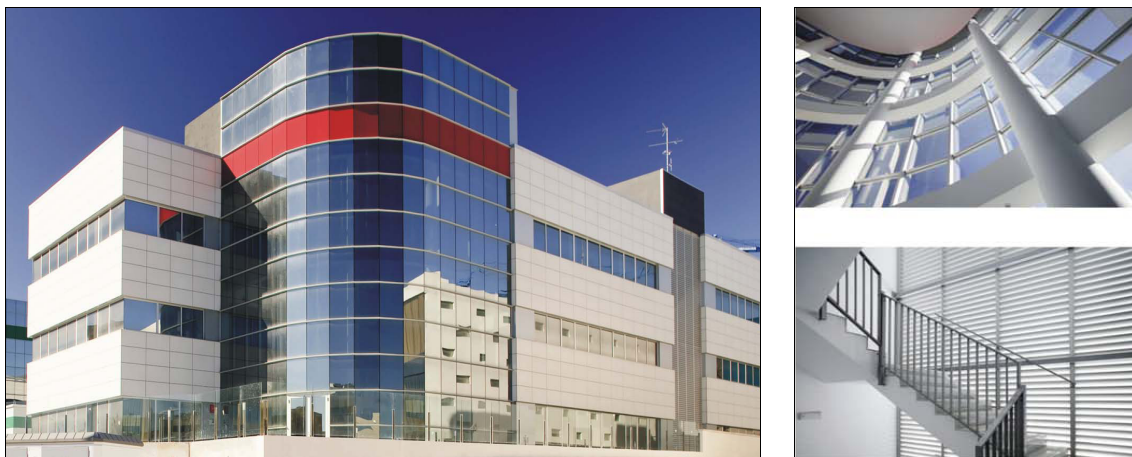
Edificio con fachada de paneles composite y celosías de MC.
